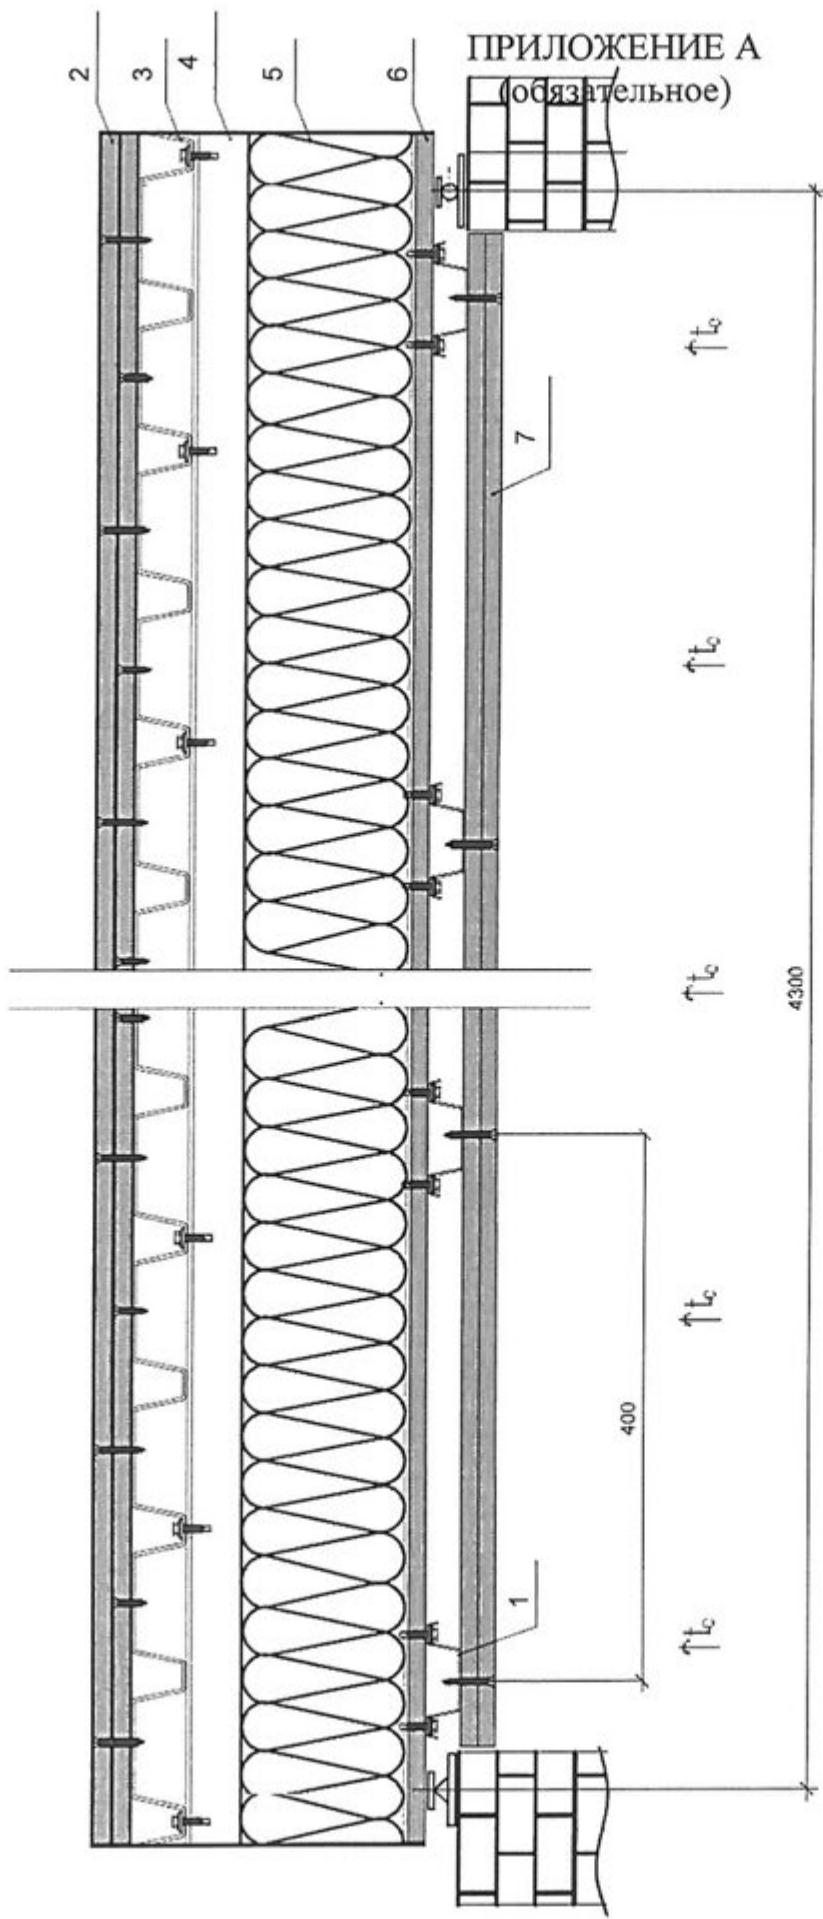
Схема конструктивного исполнения панели перекрытия (вариант 1).
